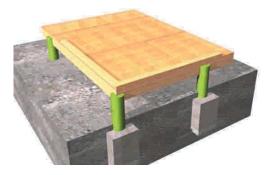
16: Plataforma de madera que se construye sobre la estructura de la fundación aislada, conformando el primer piso de la vivienda.
